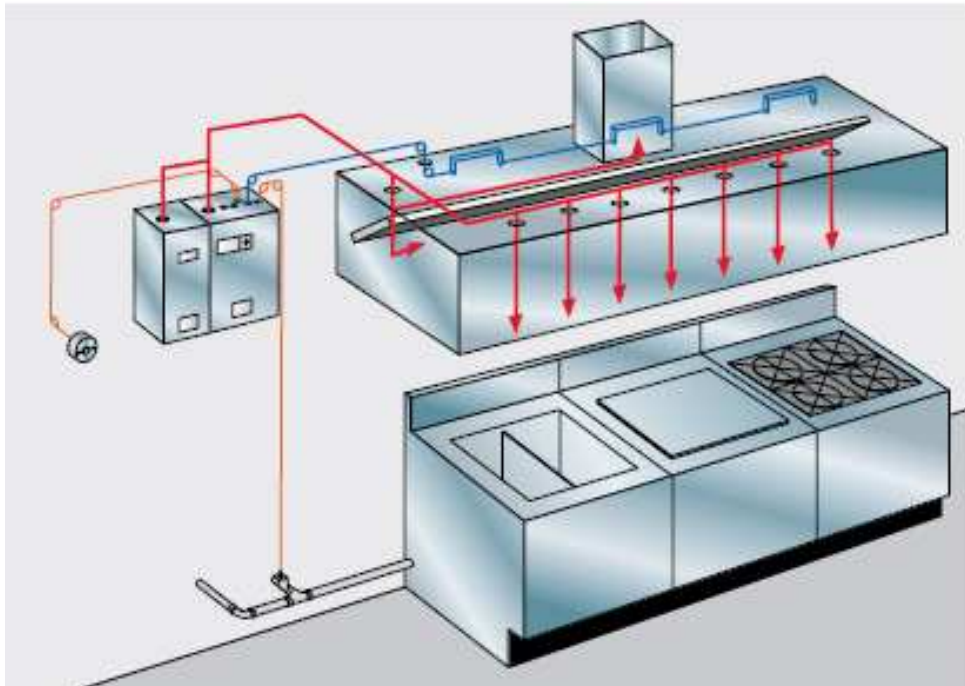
Sistema Ansul R 102 para protección solapada, caso campana isla.
